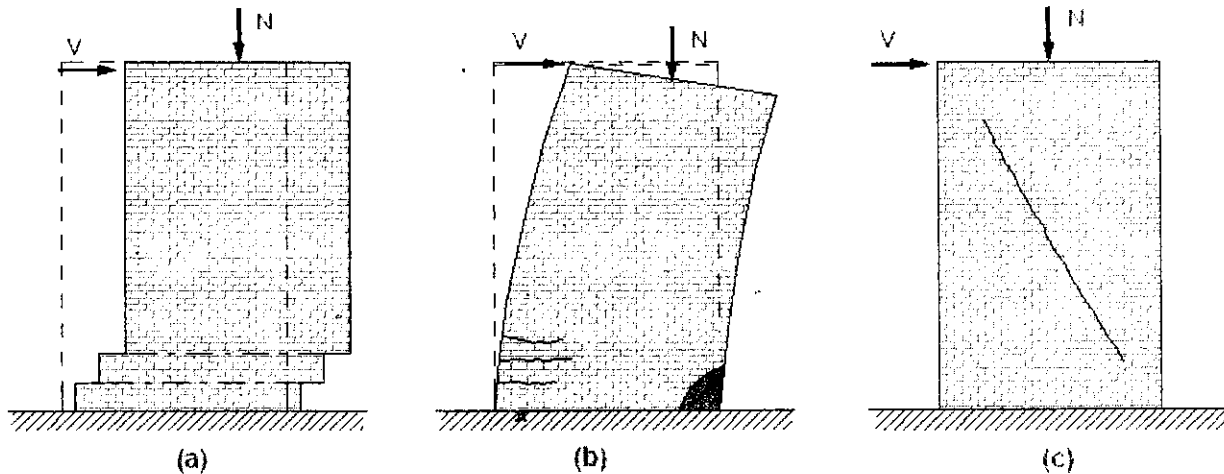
Modes de rupture d'un mur en terre s soumis un chargement dans le plan.
